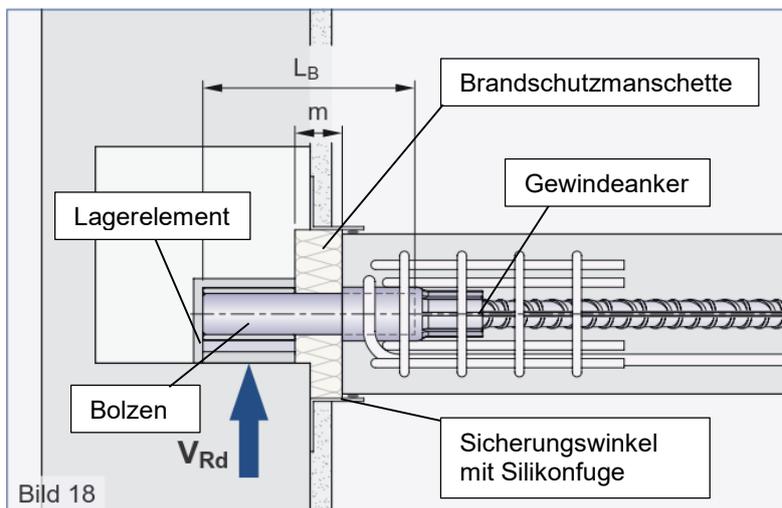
Darstellung des eingebauten TSS-Systems mit Brandschutzmanschette, aus Einbauanleitung [U3] TSS-System
